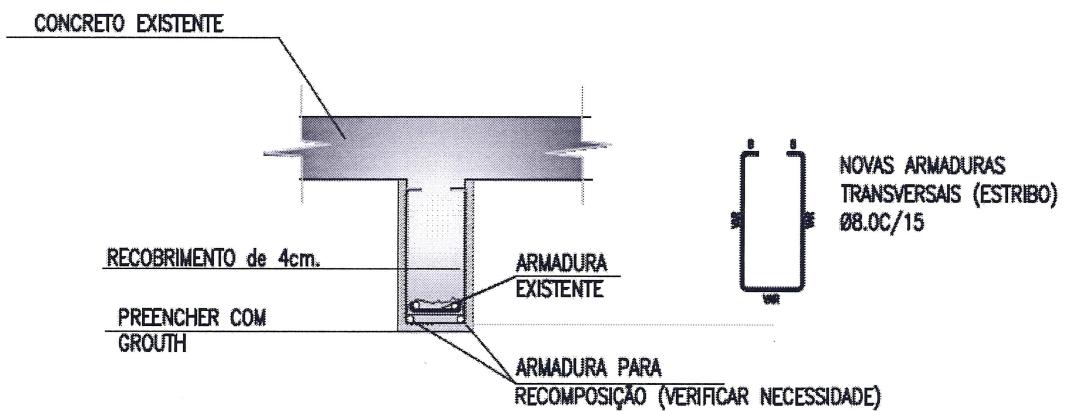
Recomposição de viga (Instalação de armadura de reforço e recobrimento com grouch)
